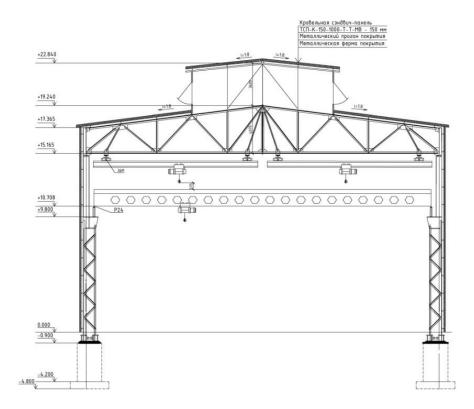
Разрез здания после реконструкции и установки оборудования
